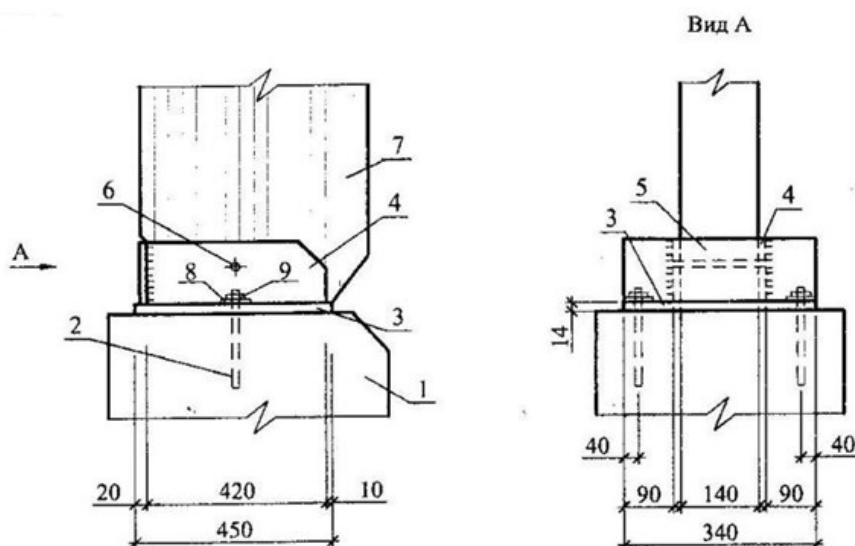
Конструктивное решение опорного узла клеедеревянной рамы: 1 – железобетонный фундамент; 2 – анкерный болт; 3 – опорная плита башмака; 4 – щеки башмака; 5 – упорная диафрагма башмака; 6 – болт; 7 – полурама; 8 – шайба; 9 – гайка
